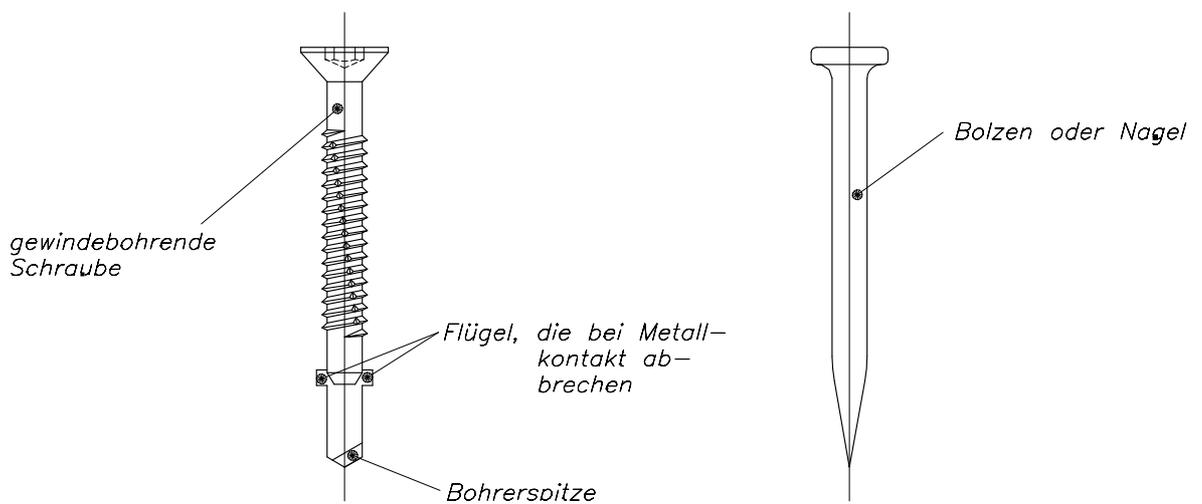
Gewindebohrende Schrauben, eingeschossene Bolzen oder Nägel
